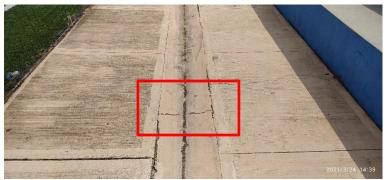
Fisuras en andén perimetral de la cancha - OCI 24-03-2021
